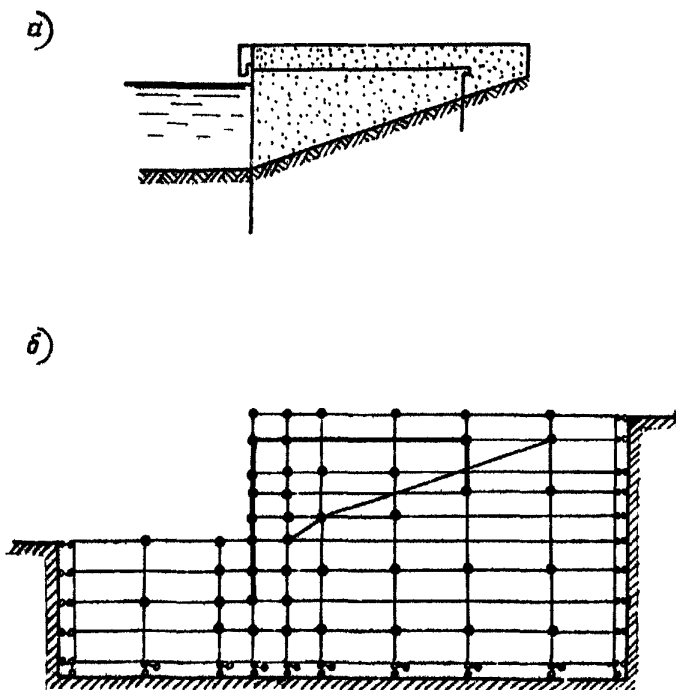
Расчетная схема заанкеренного больверка а – разрез причала; б – расчетная схема по МКЭ
